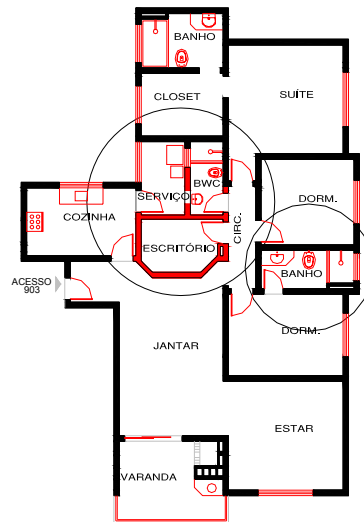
Planta Baixa do apartamento 903 – Estudo de caso A.
